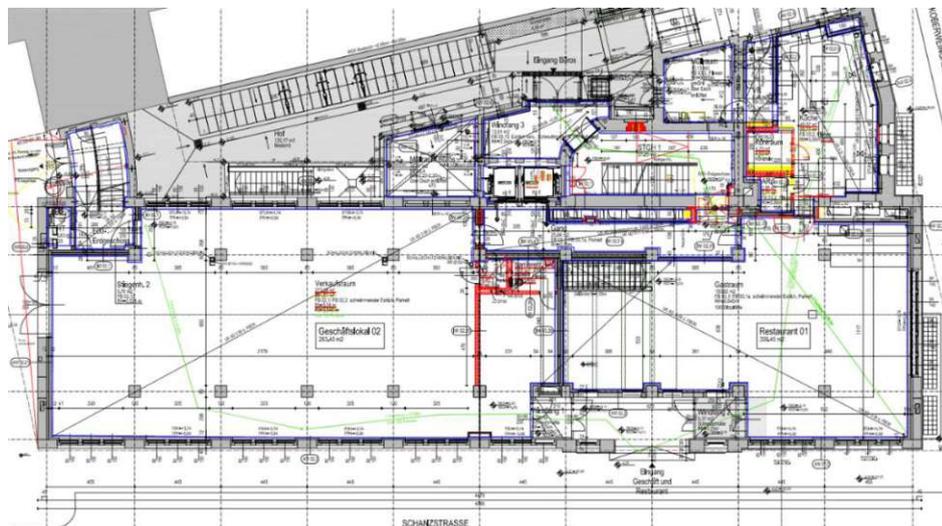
Ausführungsplan Erdgeschoss, Planverfasser: ostertag ARCHITECTS zt gmbh
